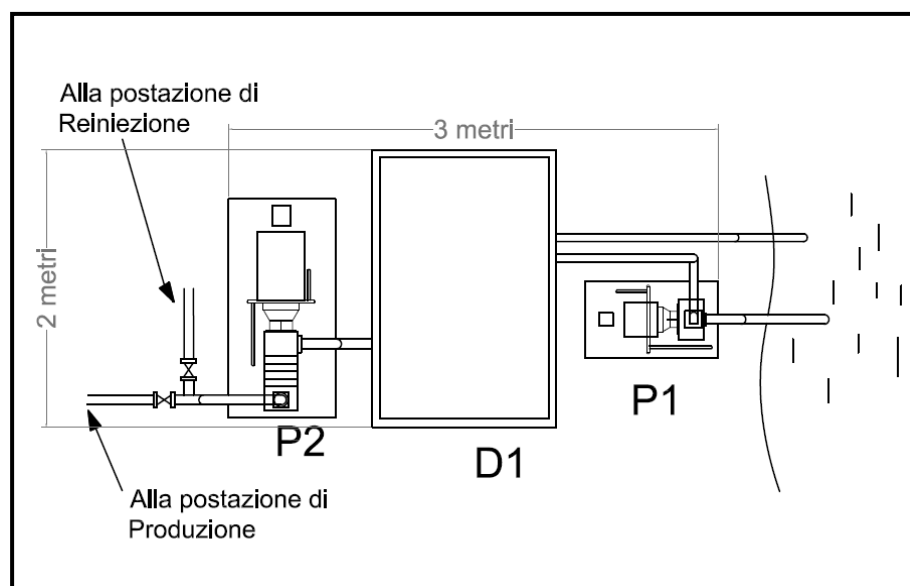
Layout in Pianta della Stazione di Prelievo Idrico
